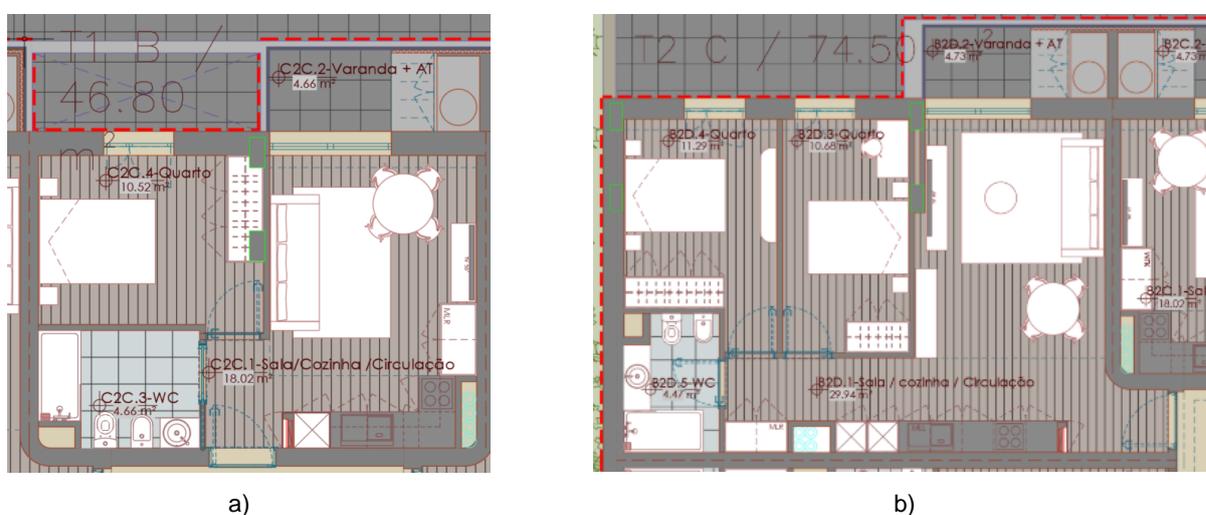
Exemplo de planta de frações: a) T1, b) T2
